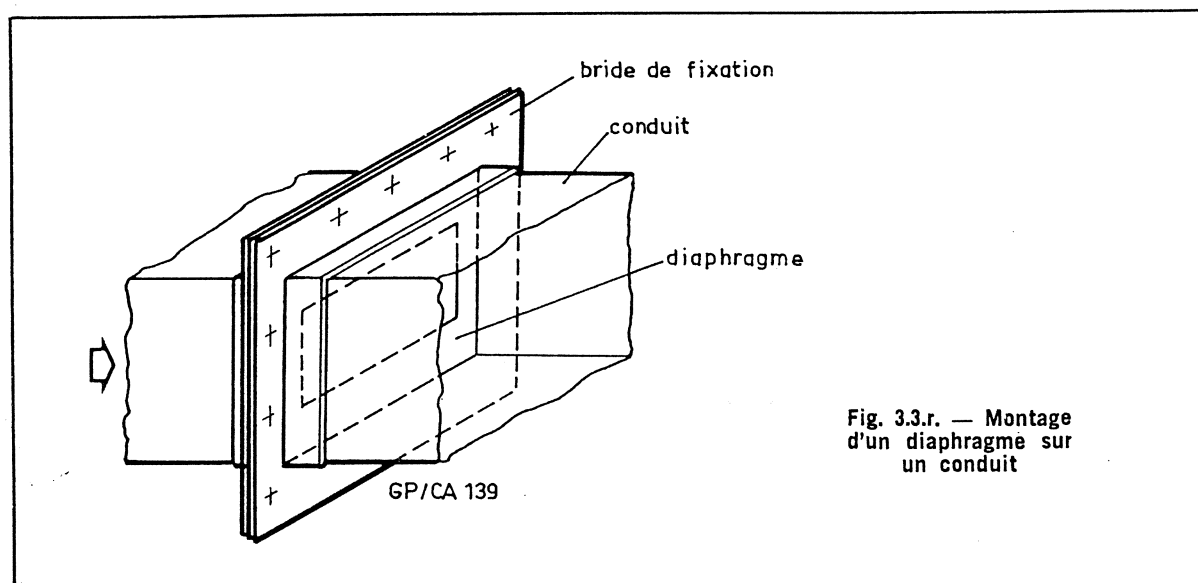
r. — Montage d'un diaphragme sur un conduit
